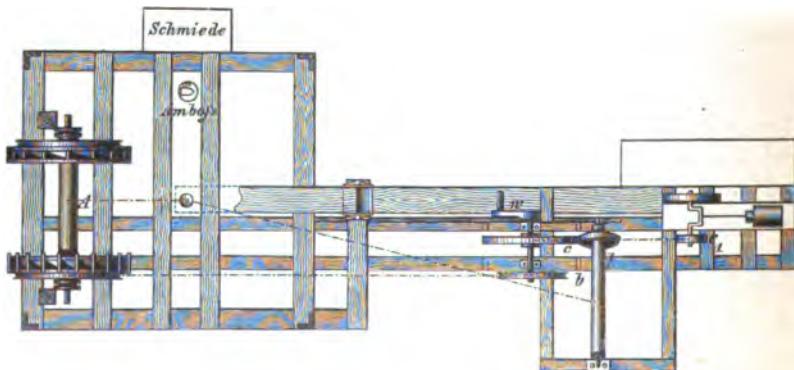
(Grundriß). Einrichtung beim amerikanischen Seilbohren.
